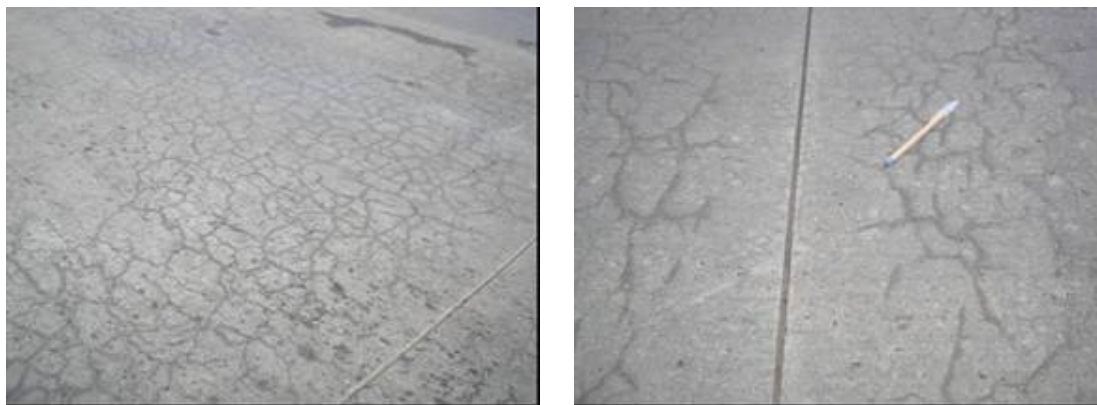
Aspecto superficial de dos losas de pavimento afectadas por RAS donde se observa el cuadro de fisuración, generalizado (foto izquierda) y concentrado en la junta transversal (foto derecha)
